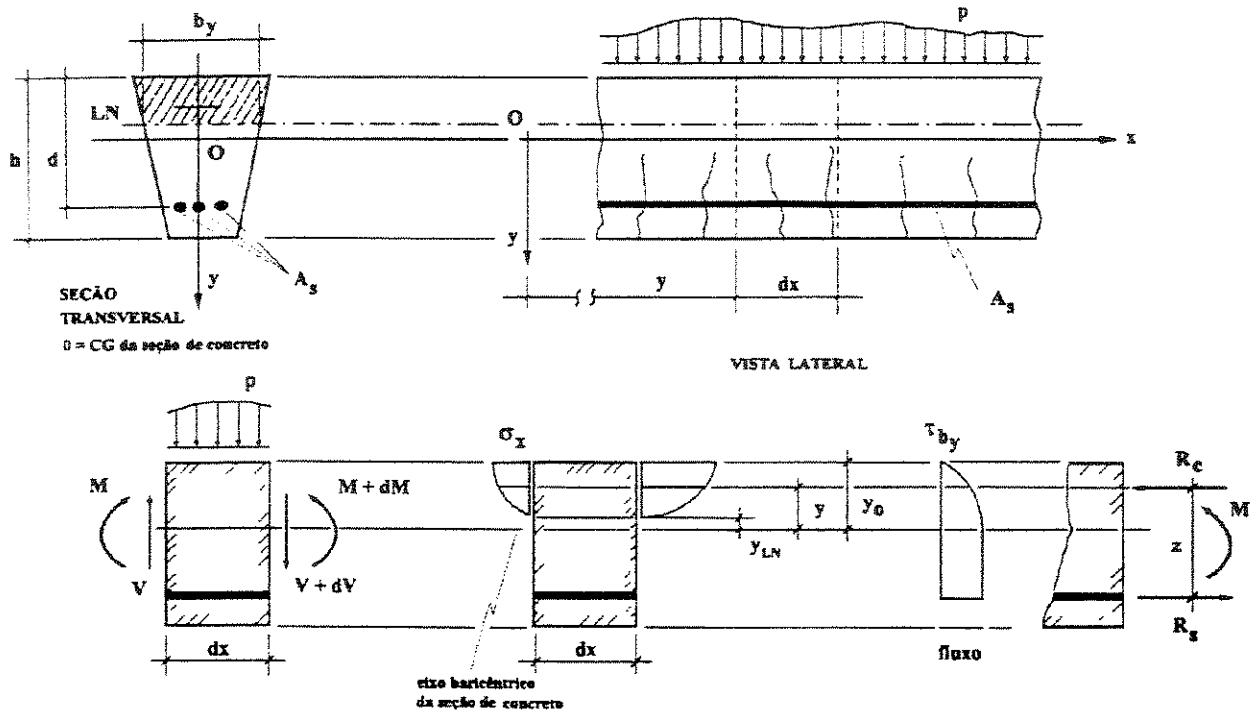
Tensão tangencial para o concreto fissurado próximo à ruptura
